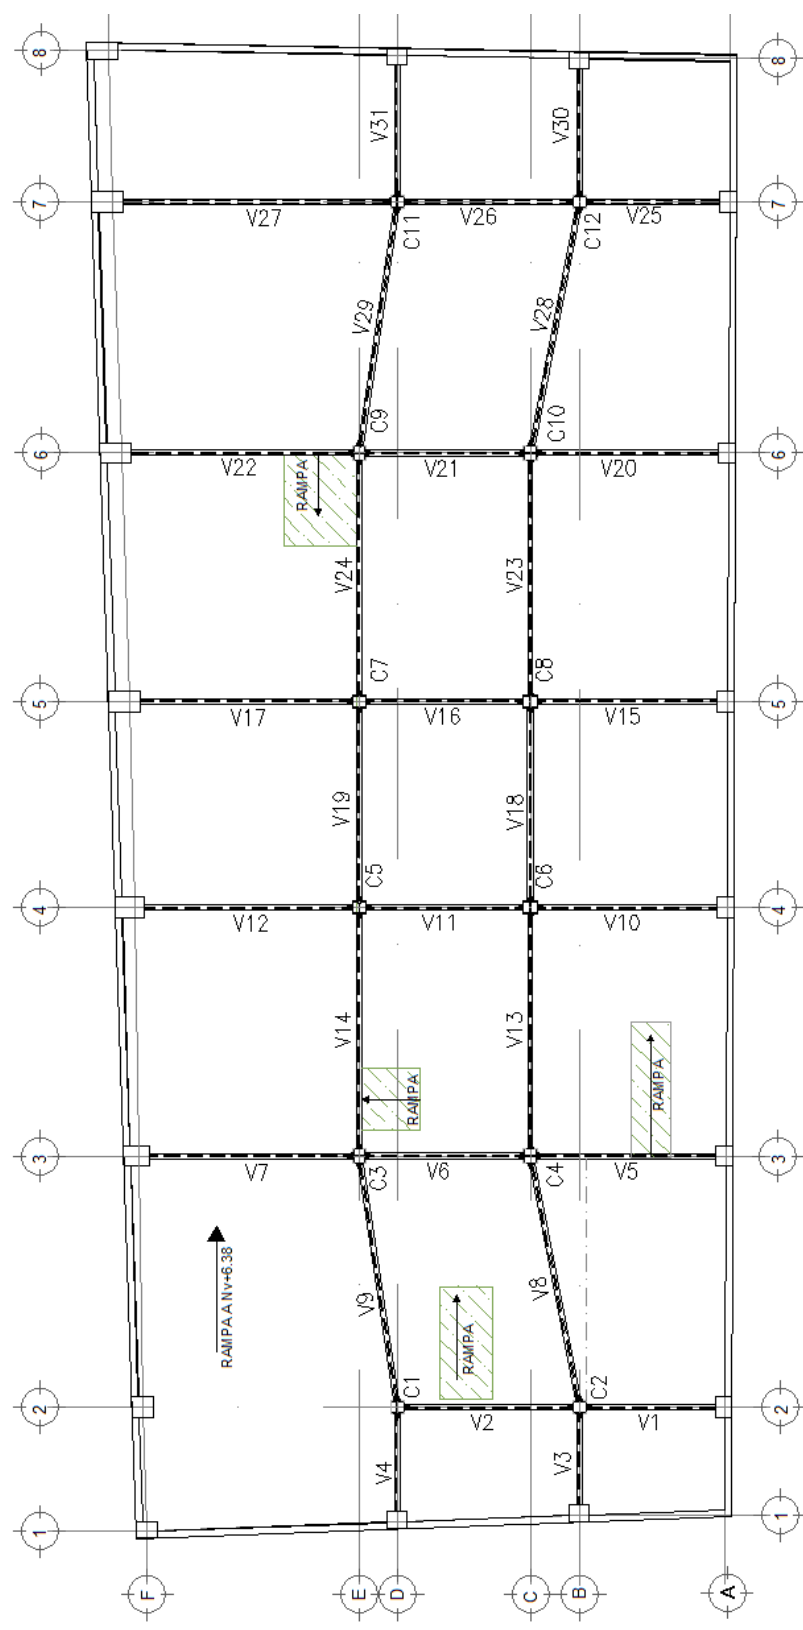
Planta estructural tipo, codificación vigas y columnas.
